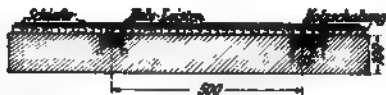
Zementdachfalzziegel. Abb. 3. Dachschiefer auf Holzschalung.
